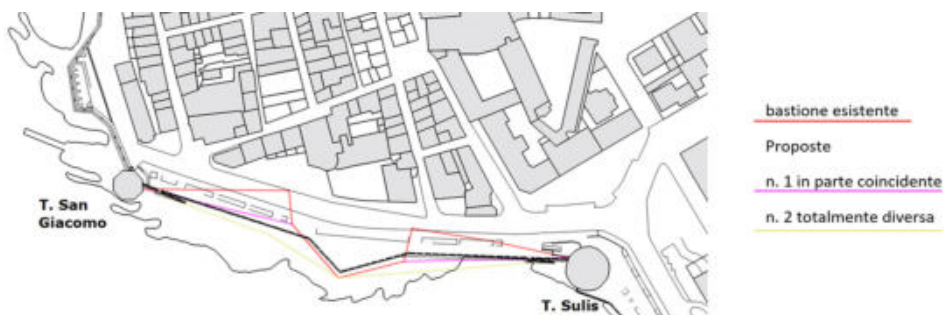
Progetto di rifacimento delle mura: allineamenti proposti su cartografia attuale (M. Dessi)
